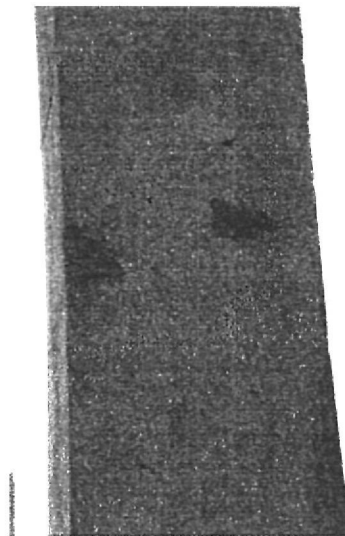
Terdapatnya kesan tampalan pada struktur tiang
